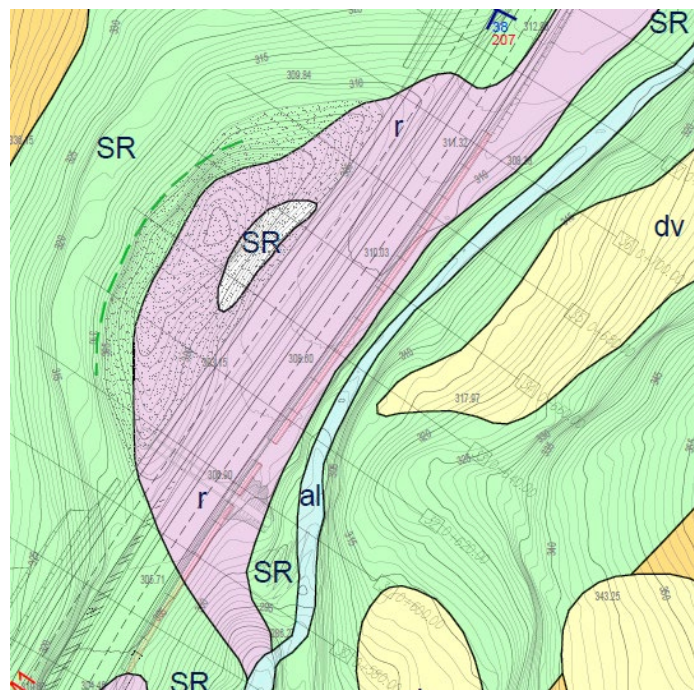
stralcio planimetro zona colmata (area con retino color rosa- unità geologica r)
